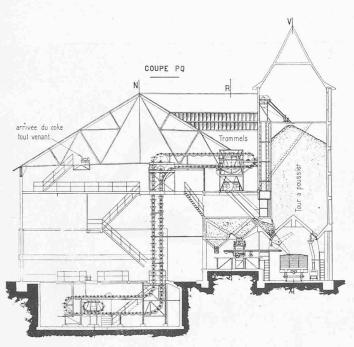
Halle à coke. Coupe transversale par l'élévateur.
